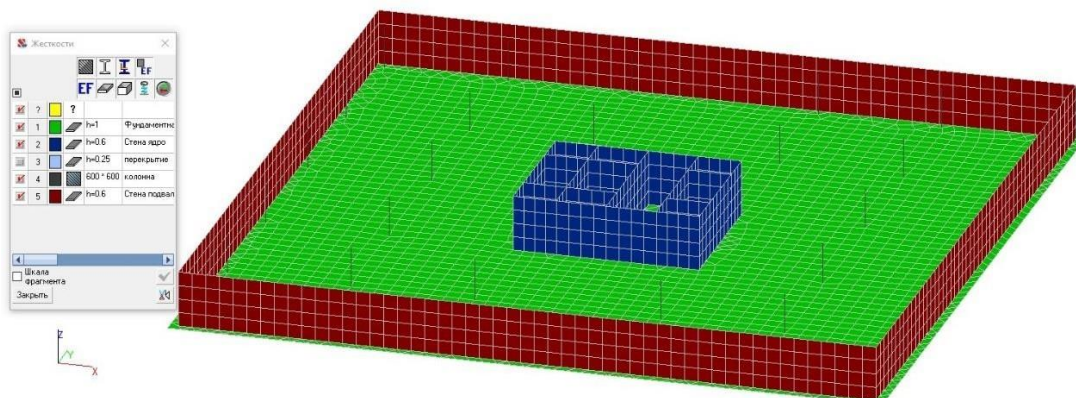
Конечно элементная схема фундаментной плиты
